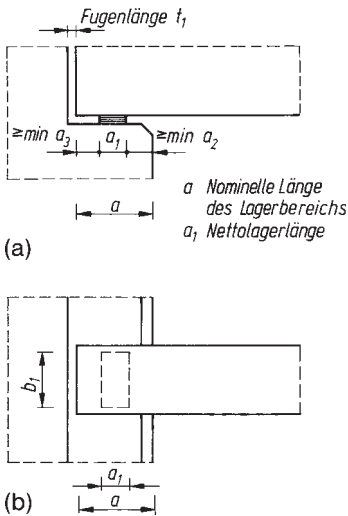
Auflagerbereich; a) Ansicht, b) Grundriss
